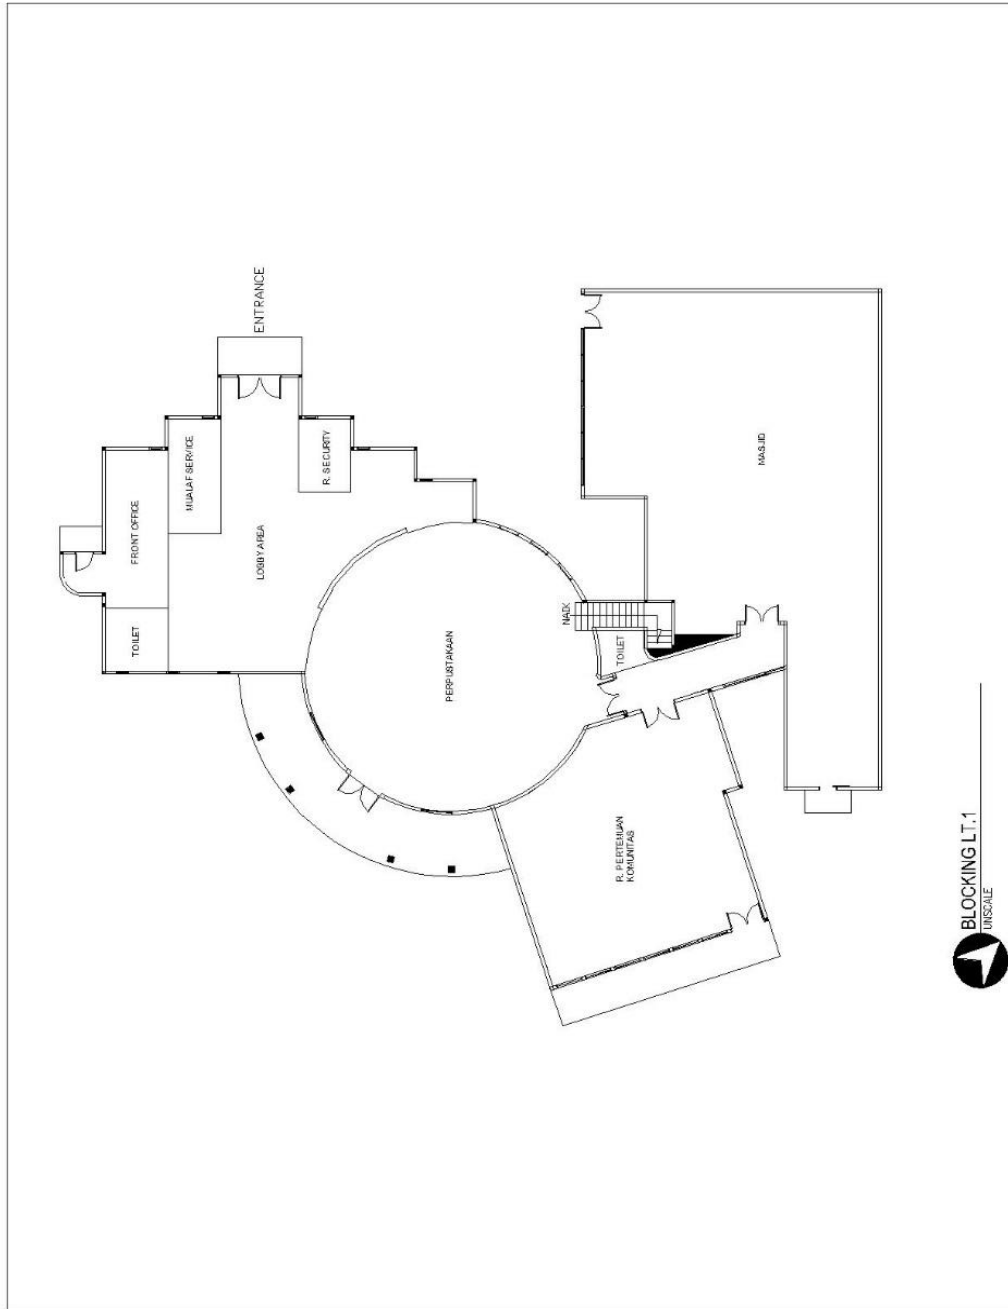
Zoning Muallaf Center Lantai 1
